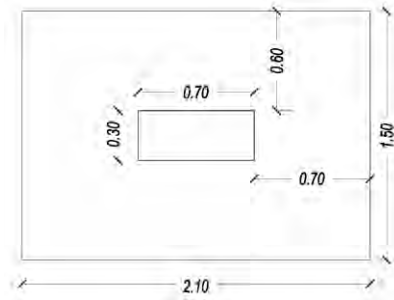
Dimensiones de la zapata aislada eje A-3
